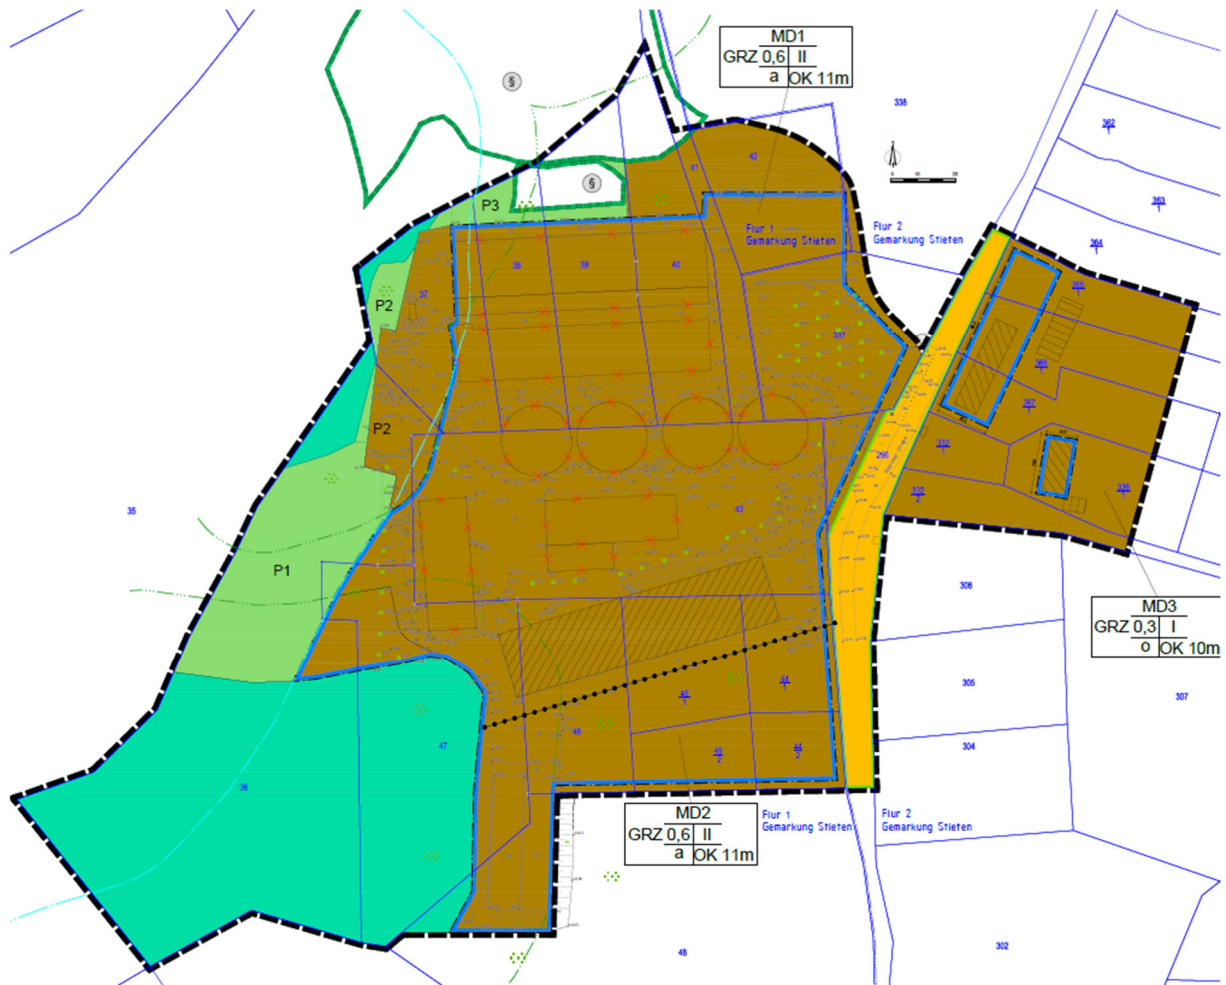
Planzeichnung (Vorentwurf, Auszug) des Bebauungsplanes Nr. 4 o. M.
